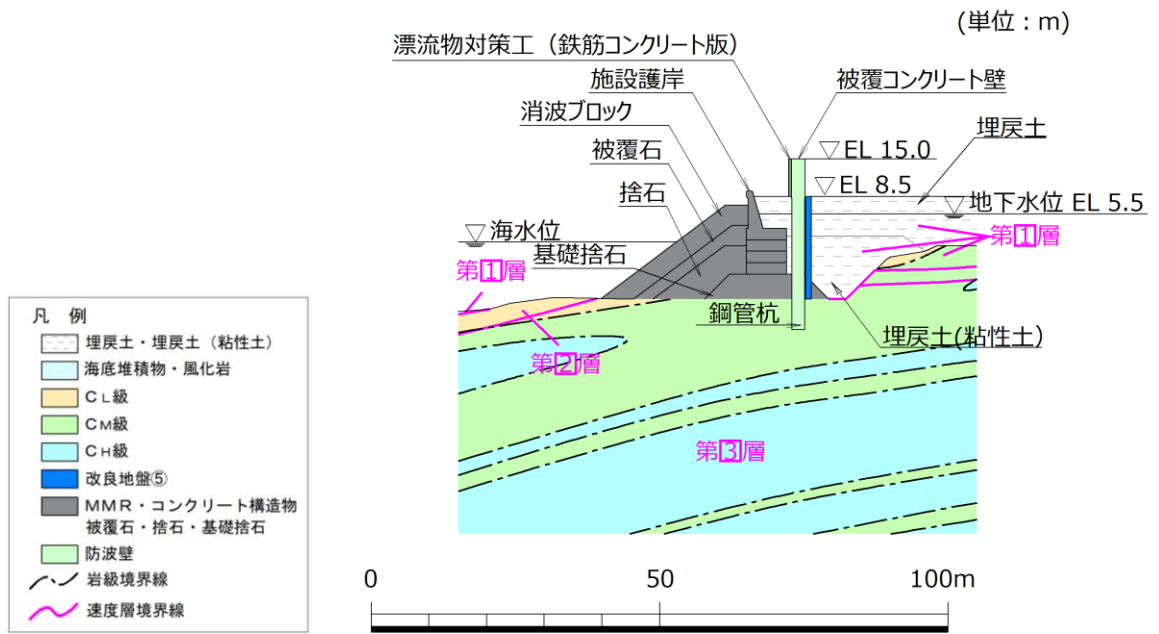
防波壁 (多重鋼管杭式擁壁) の横断面図 (①-①断面)
